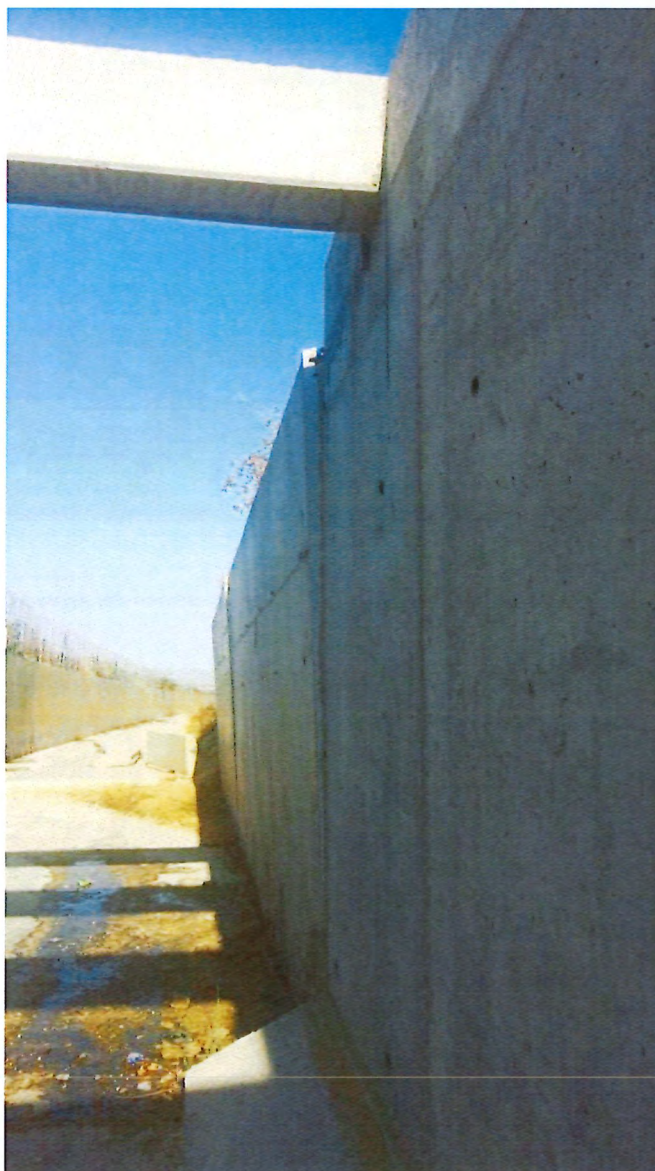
Primer plano: inicio de inclinación del muro. Fondo: Tramo desplomado
